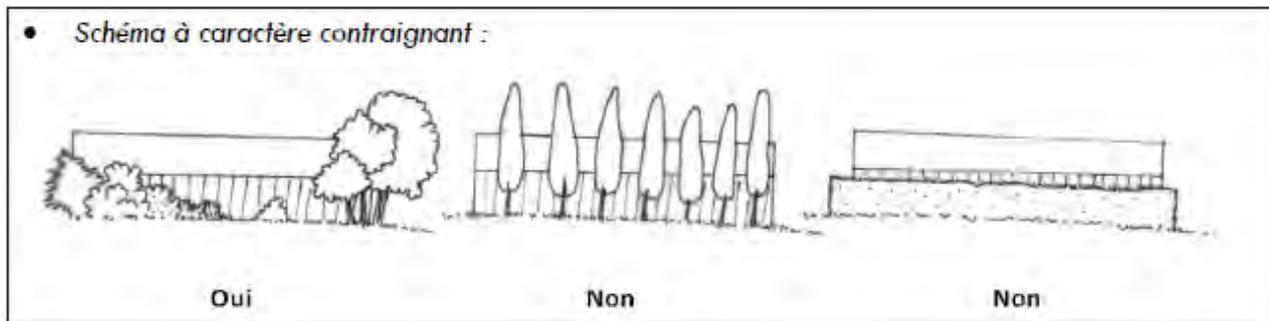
Plantations accompagnant le bâti -Règlement p. 137
